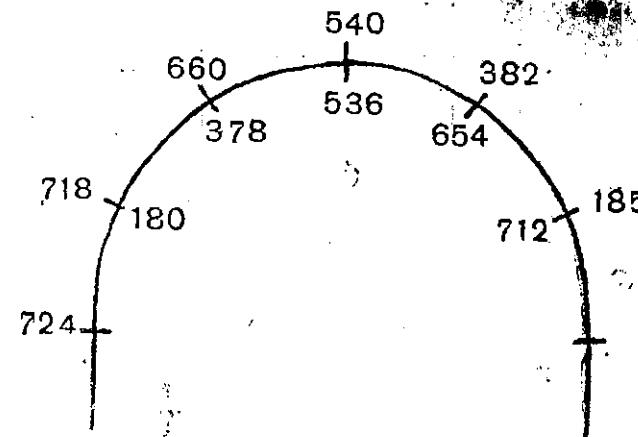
Расстановка размеров на черновой зарисовке обмера арки по способу П. Покрышкина
